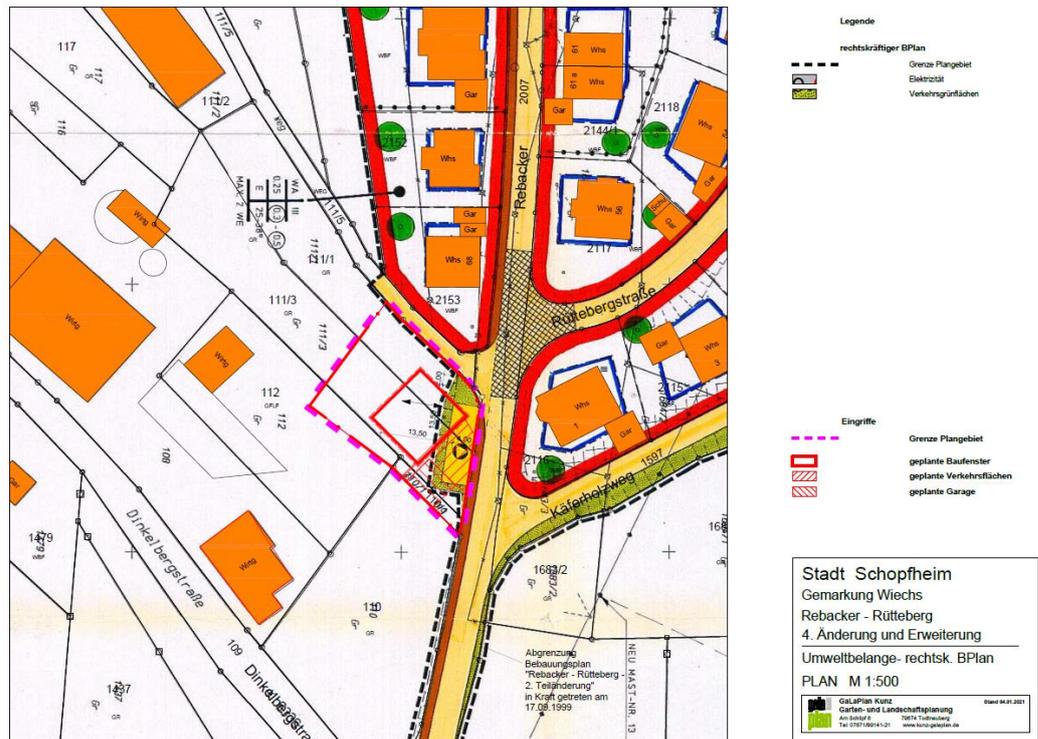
Überlagerung des Plangebiets mit der Darstellung des rechtskräftigen Bebauungsplans „Rebacker – Rütteberg – 2. Teiländerung“ (Quelle: Kunz GaLaPlan)
